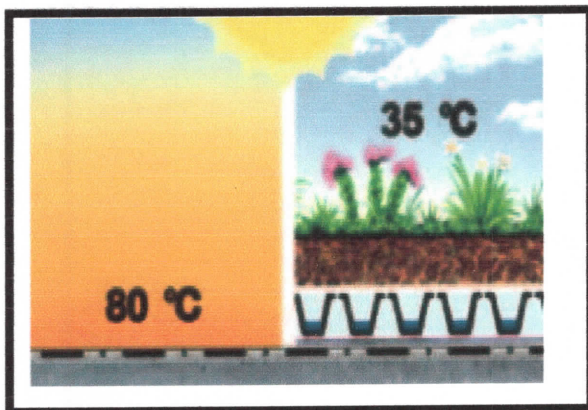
protection solaire par toit végétalisé, source: (Loïc MARCHETTO, et autre)
